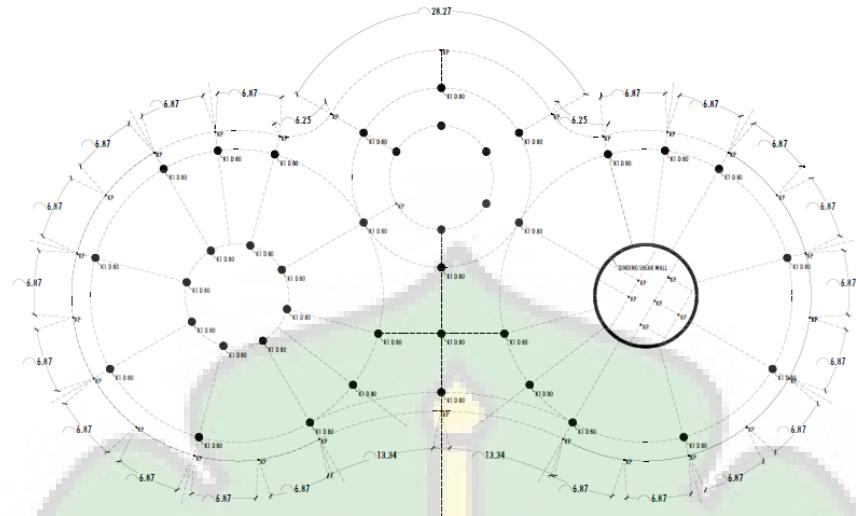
Denah Rencana Kolom Lantai 1
